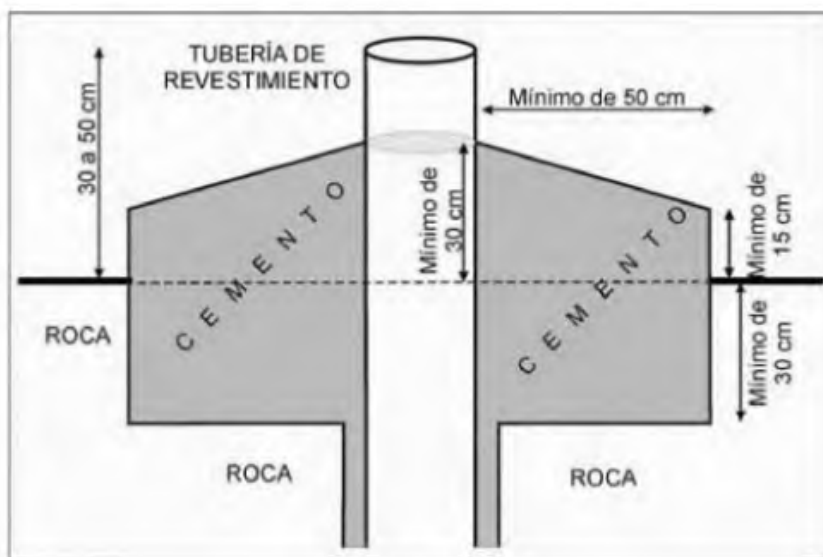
croquis d'alçat i planta de la placa de ciment a la boca del sondeig (font: Pla Hidrològic de les Illes Balears)
